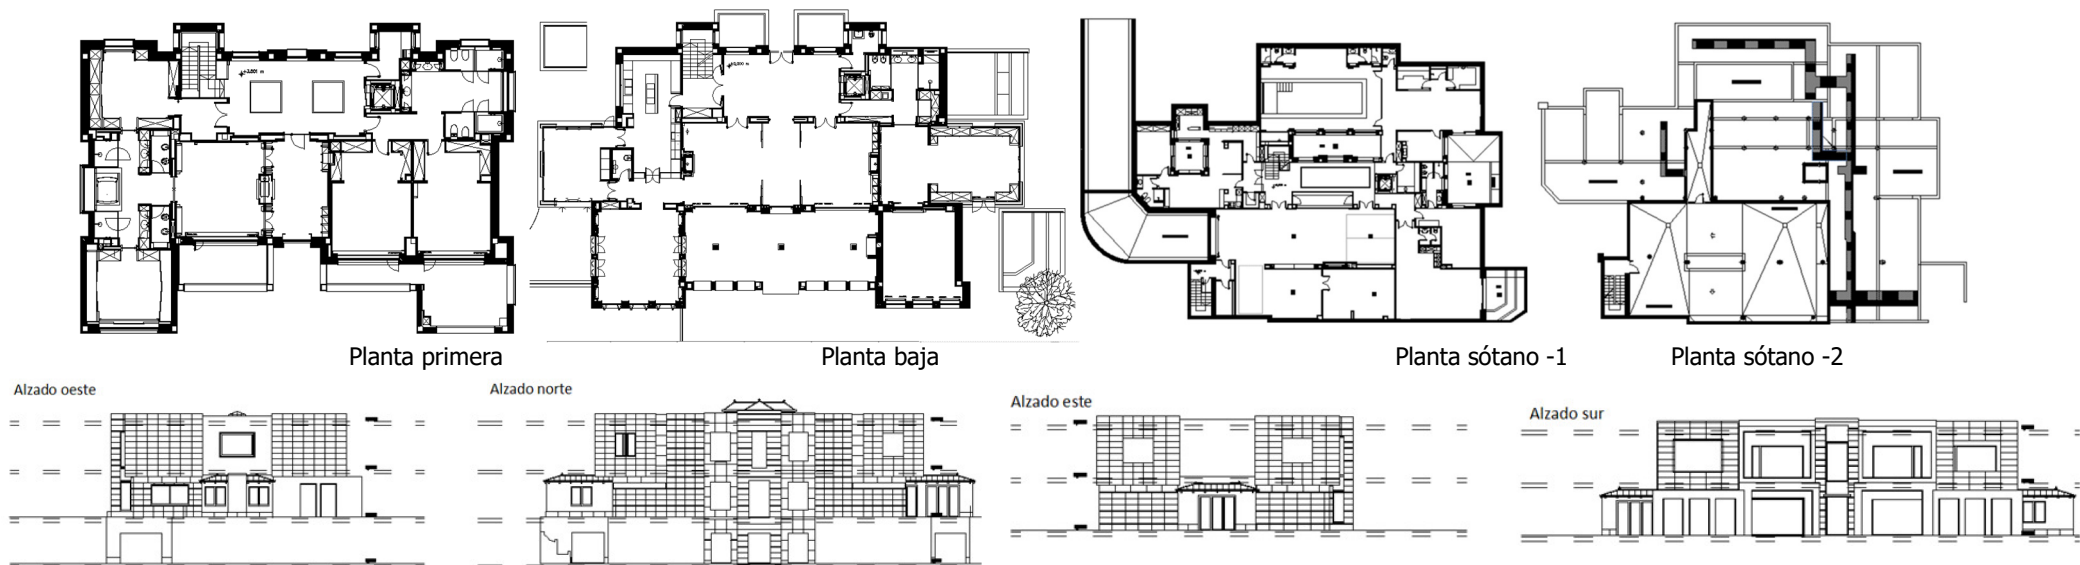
Plantas y alzados de la vivienda objeto. (Elaboración propia) Más información gráfica de plantas y alzados del proyecto en Anexo nº1 adjunto al final del trabajo.
